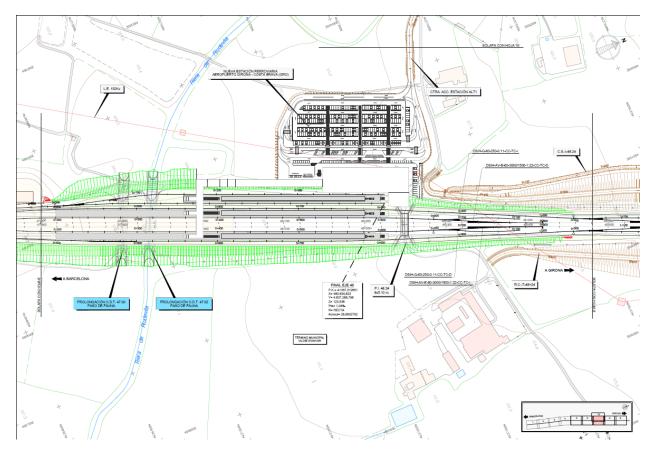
Plano de planta de estación y urbanización Alternativa 1
